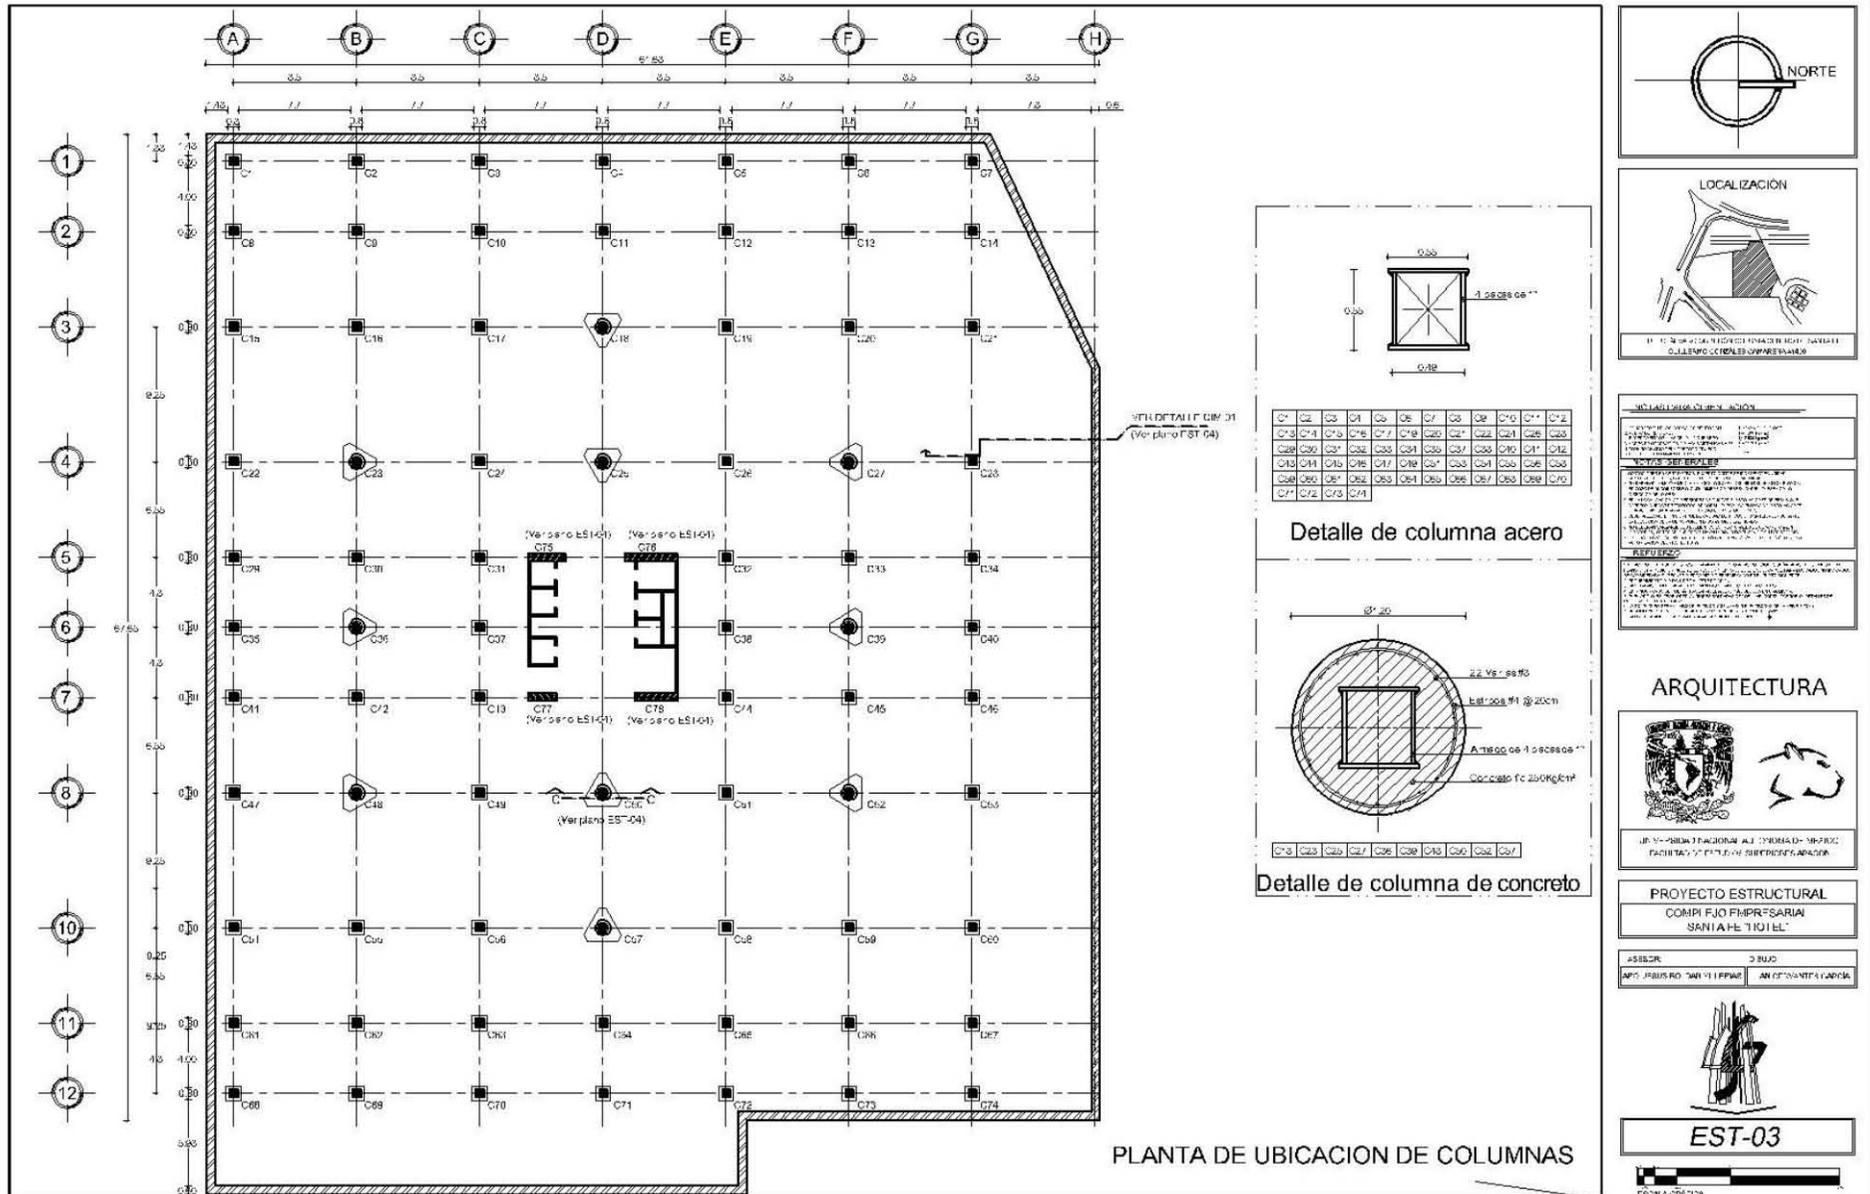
Plano Est-03; Ubicación de columnas. Edición propia.
